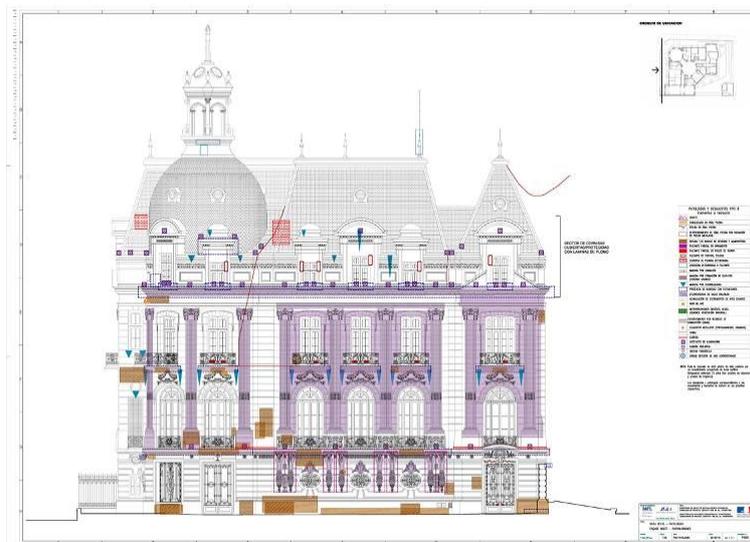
Fachada sobre calle Arroyo. Patologías. Fuente: B4FS-JL&A.
